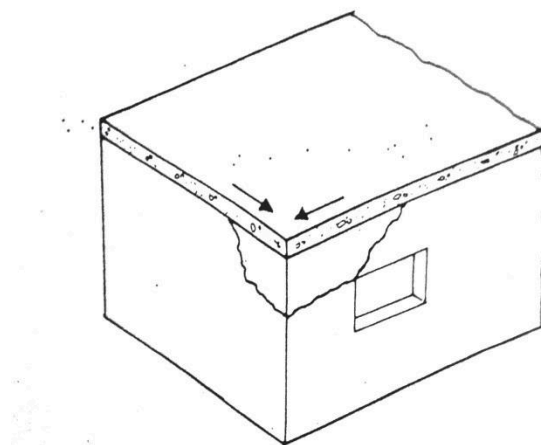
Fissura de cisalhamento provocado por expansão térmica da laje de cobertura (THOMAZ, 1989).
